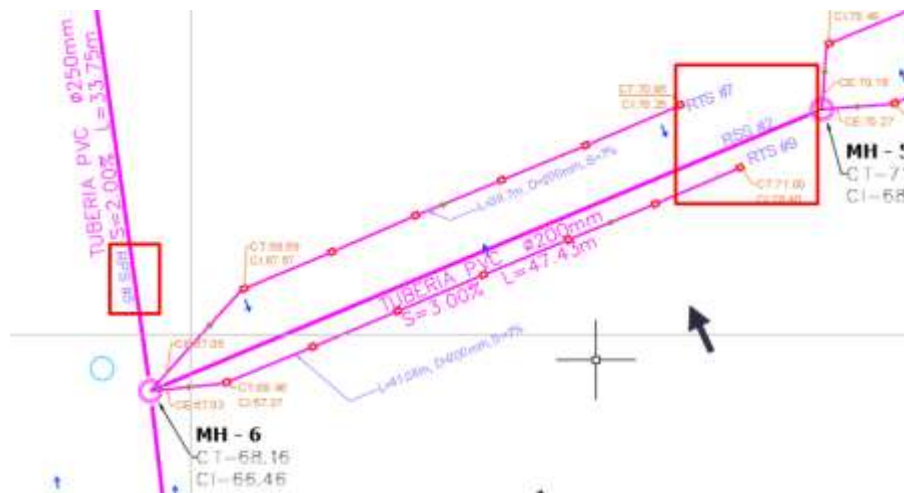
9 Tramo en planta del sistema de alcantarillado sanitario
